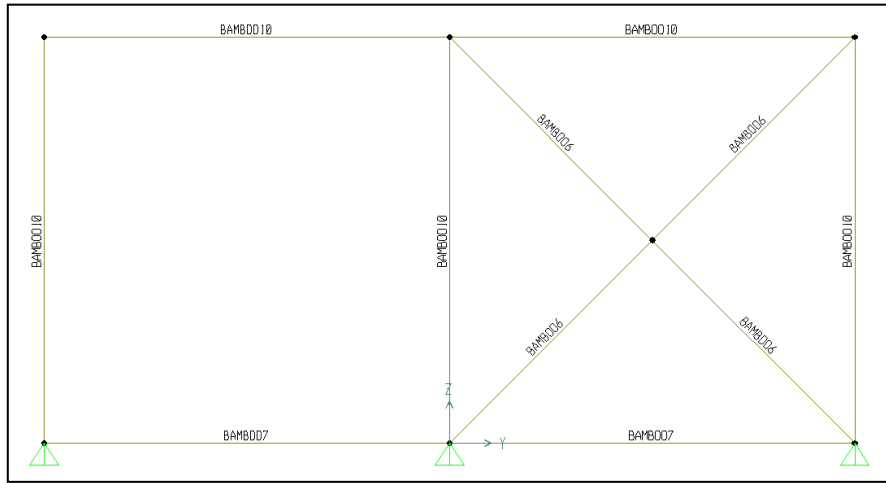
Diámetro de los elementos de la estructura, marco frontal y trasero (plano yz).
